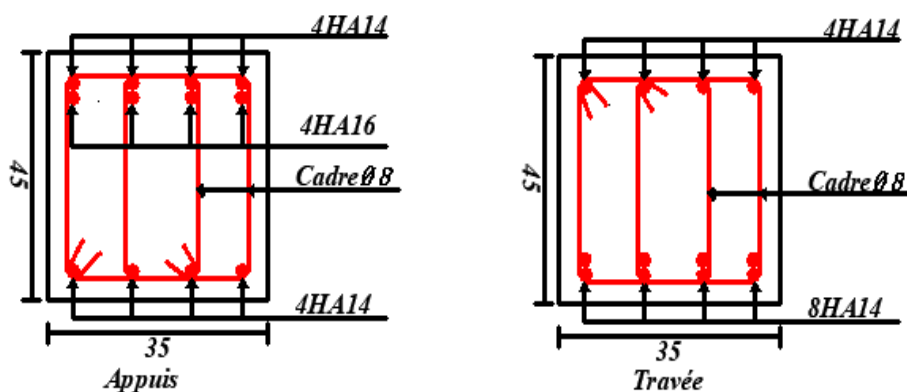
Schéma de ferrailage de la poutre principale des planchers courants
